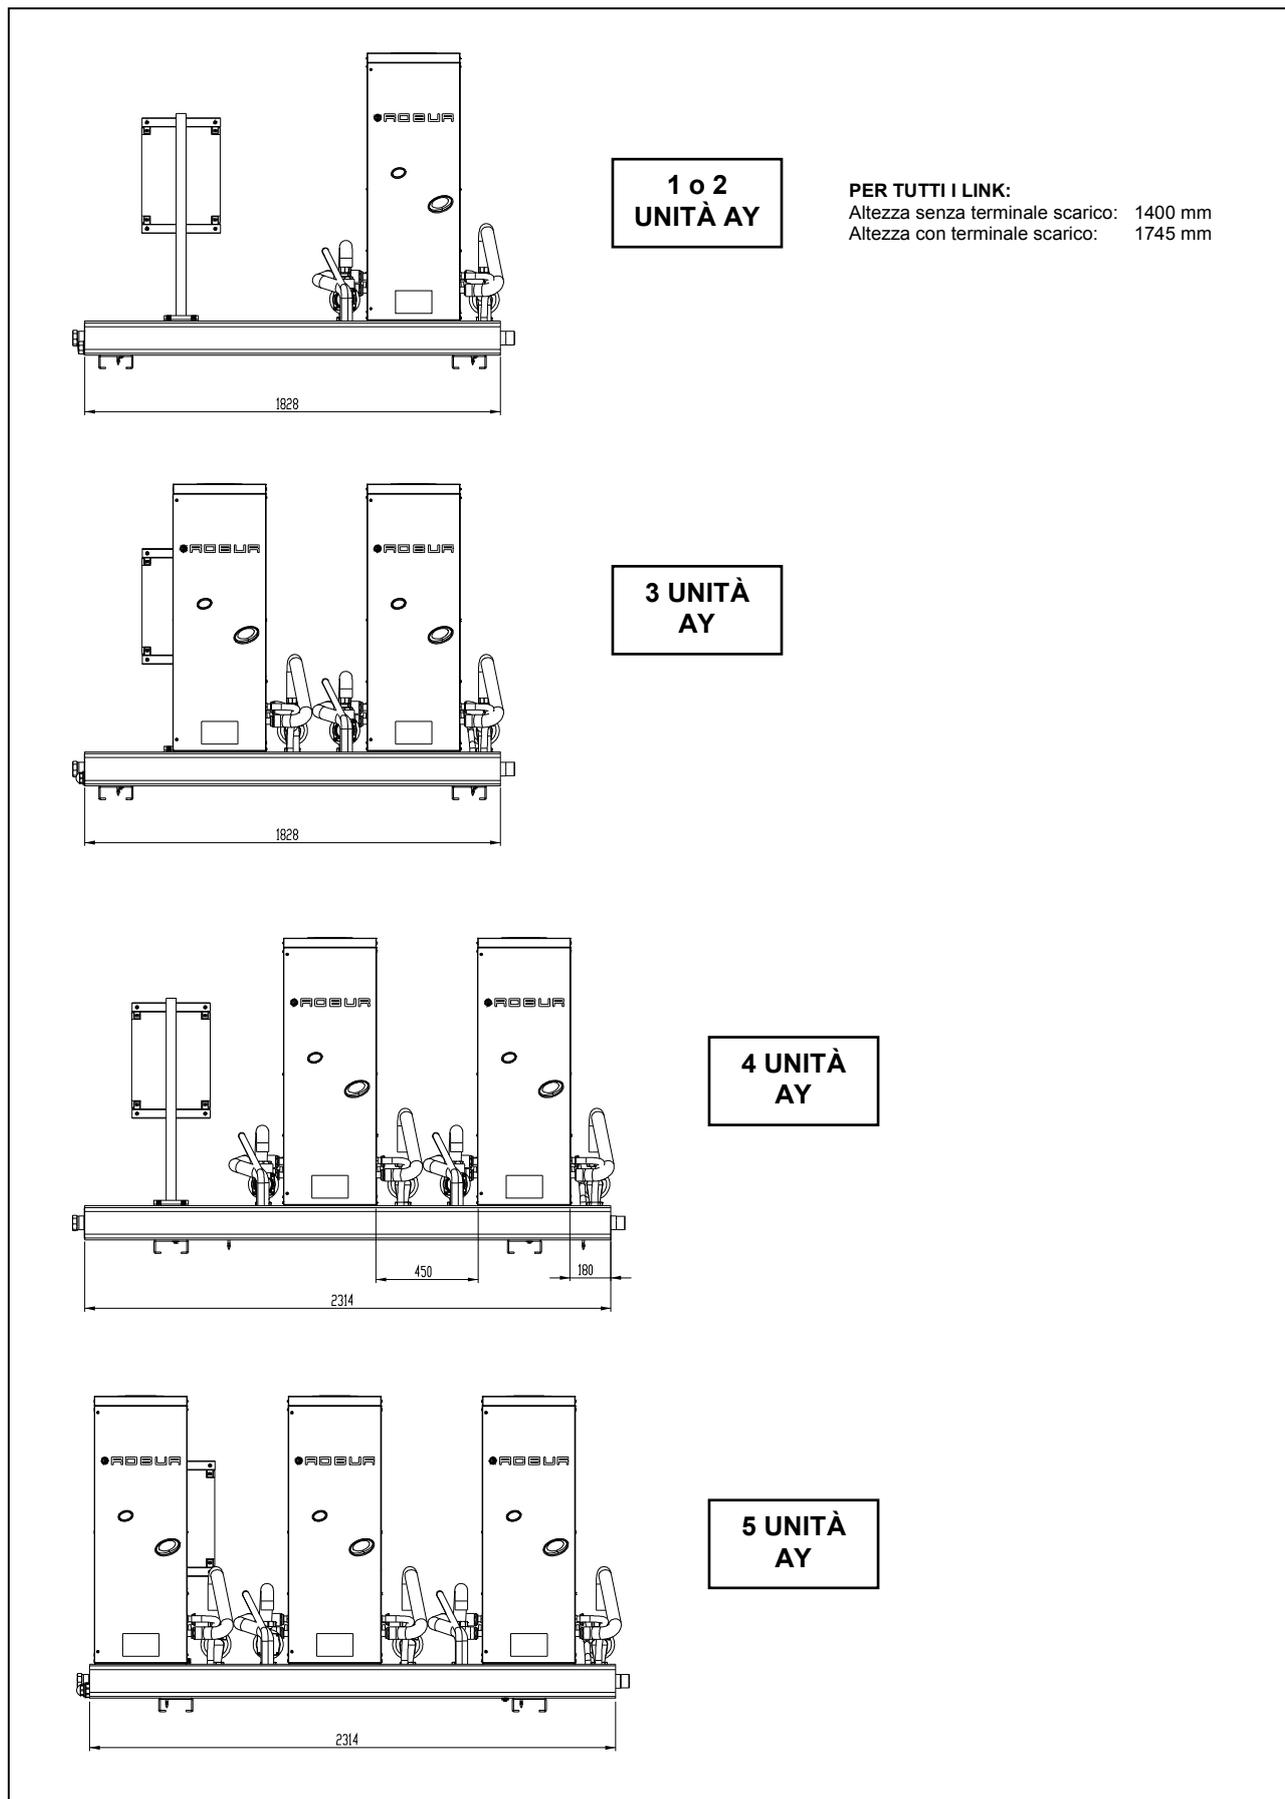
Dimensioni link composti da unità AY00-120 Condensing – vista frontale (quote espresse in mm)
